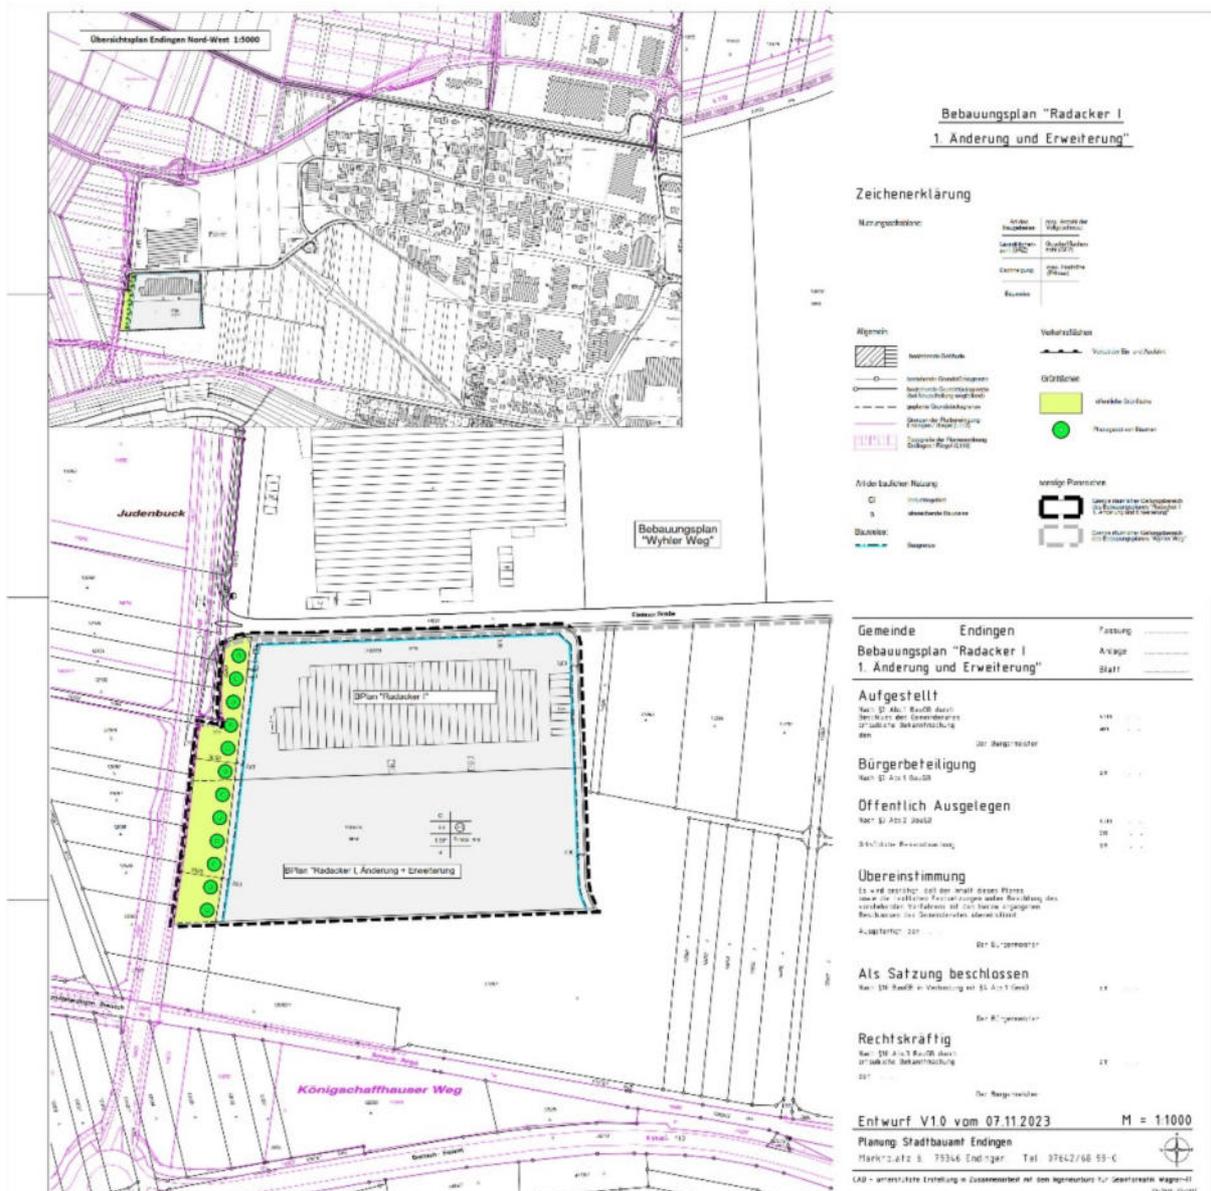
Bebauungsplan Radacker I +Erweiterung
